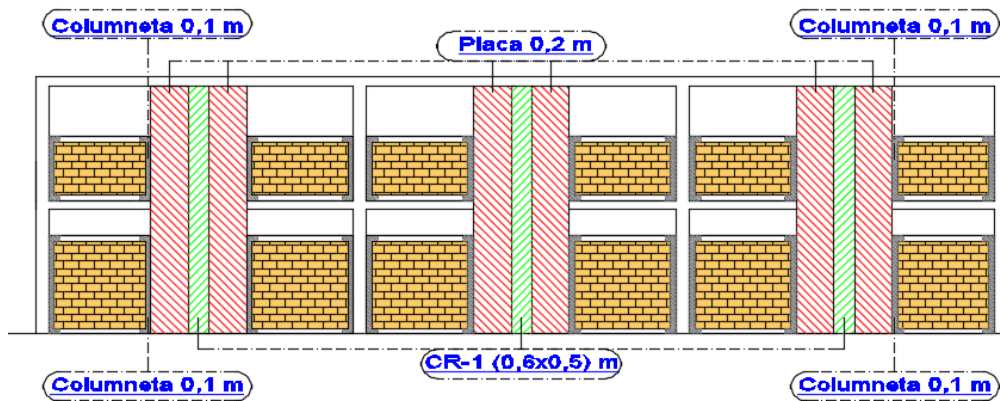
Implementación de nuevos elementos estructurales como muros de corte y columnetas
